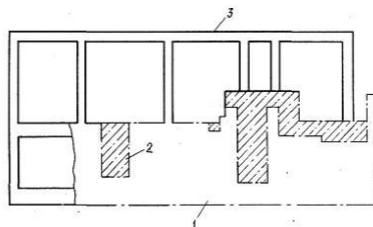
Возведение на сущ. фундаменте облегченных конструкций рамного типа, 1 – сущ. фундамент; 2 - монолитный бетон; 3 - конструкции рамного (стенчатого) типа
